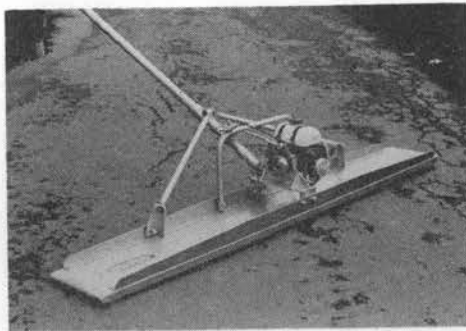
東京フレグ CT-25 コンクリートタンバ
